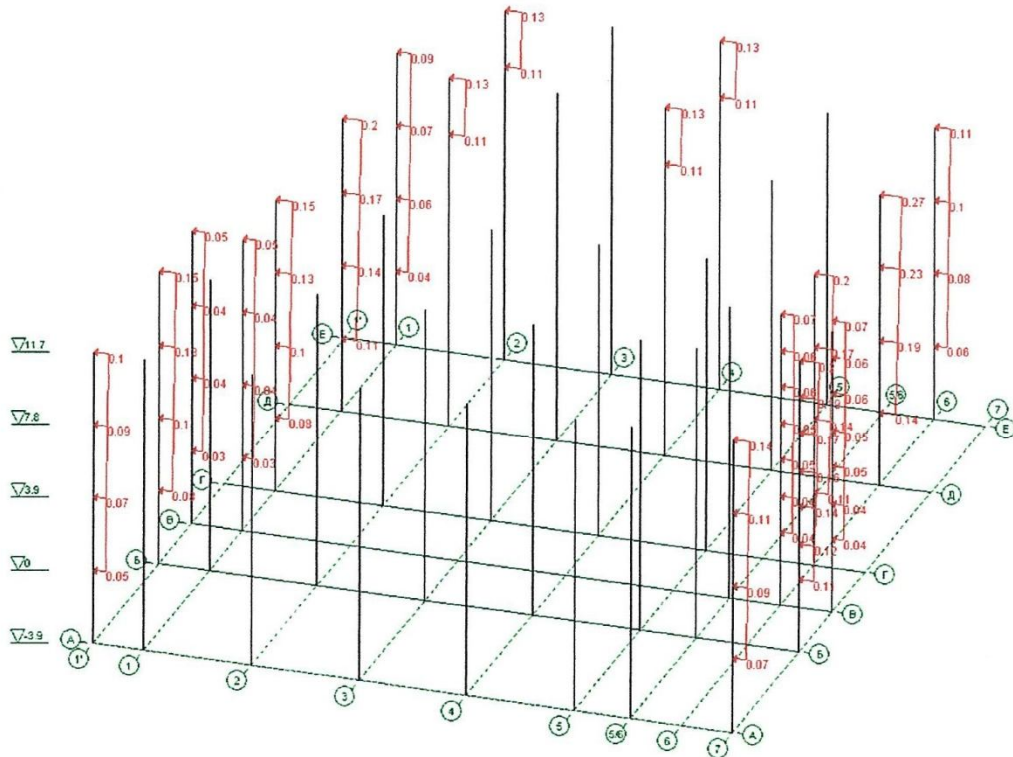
Схема завантаження 8 – навантаження на колони від вітру
